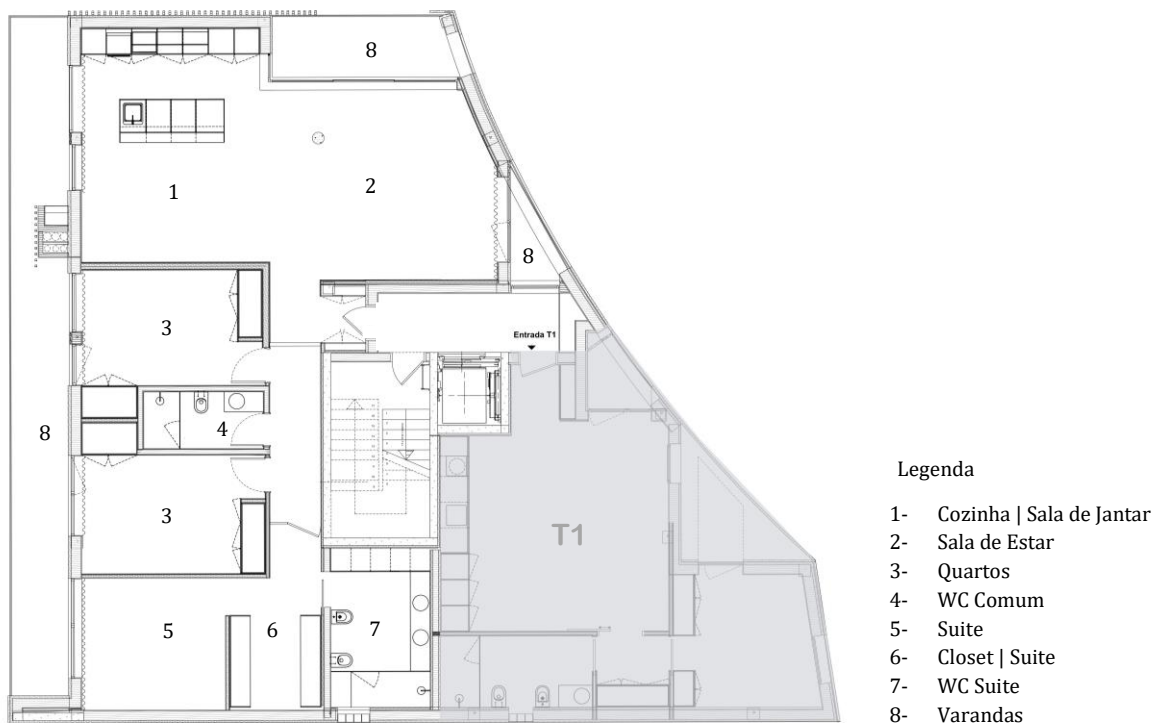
Planta base do apartamento T3. Fonte: 2L' atelier
